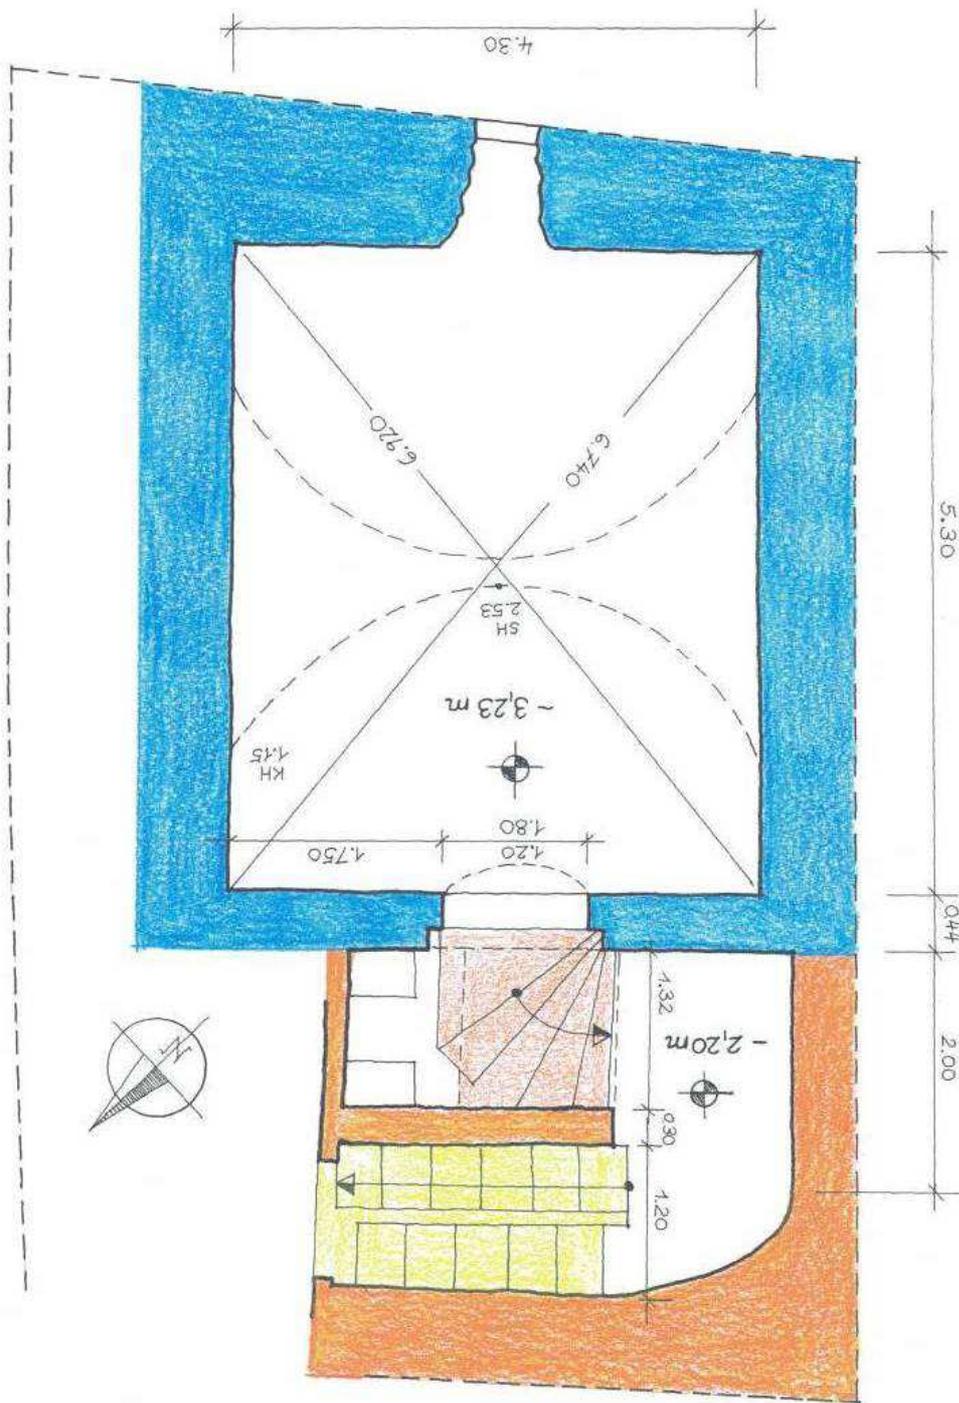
Görnische Gasse 35: Grundriss des Erdgeschosses, Vermessung
